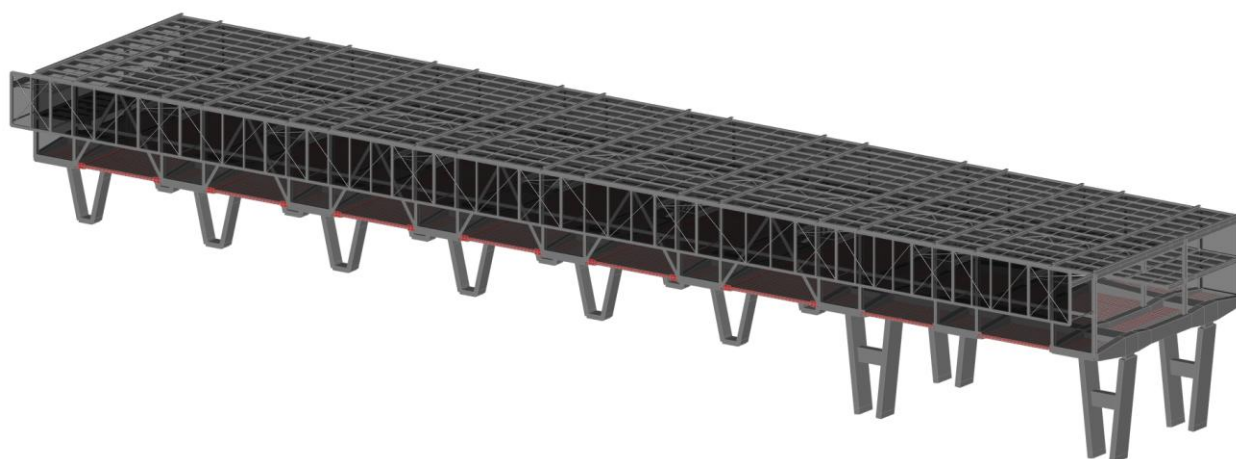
Modelo de cálculo Edifício Ponte: Predominância da Fachada Sul.
